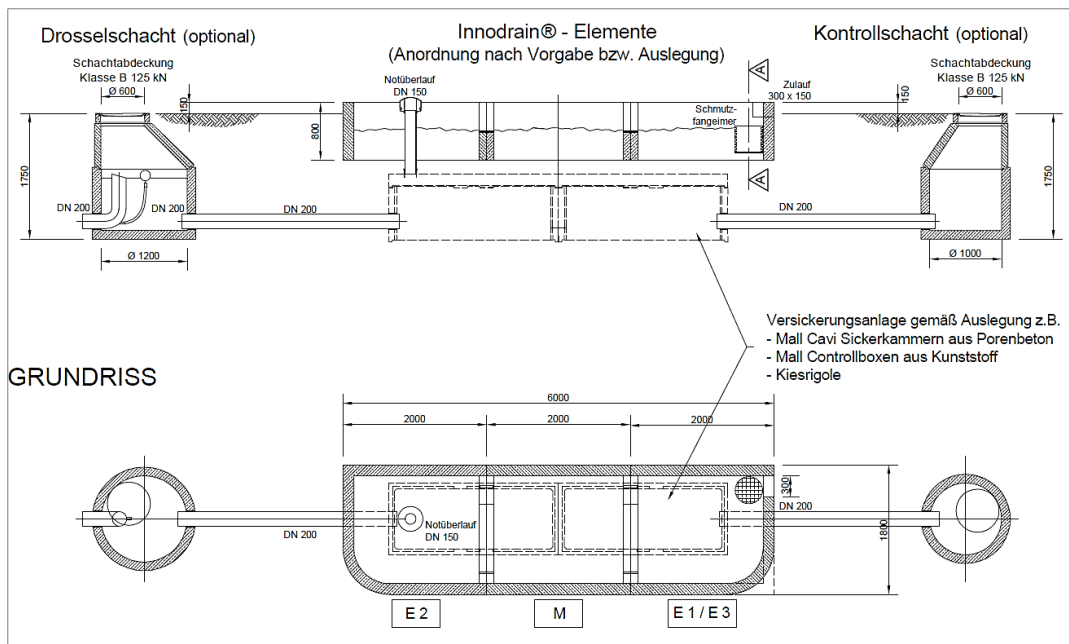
Längsschnitt und Grundriss Tiefbeet-Rigole (INNODRAIN® -System von Mall).
